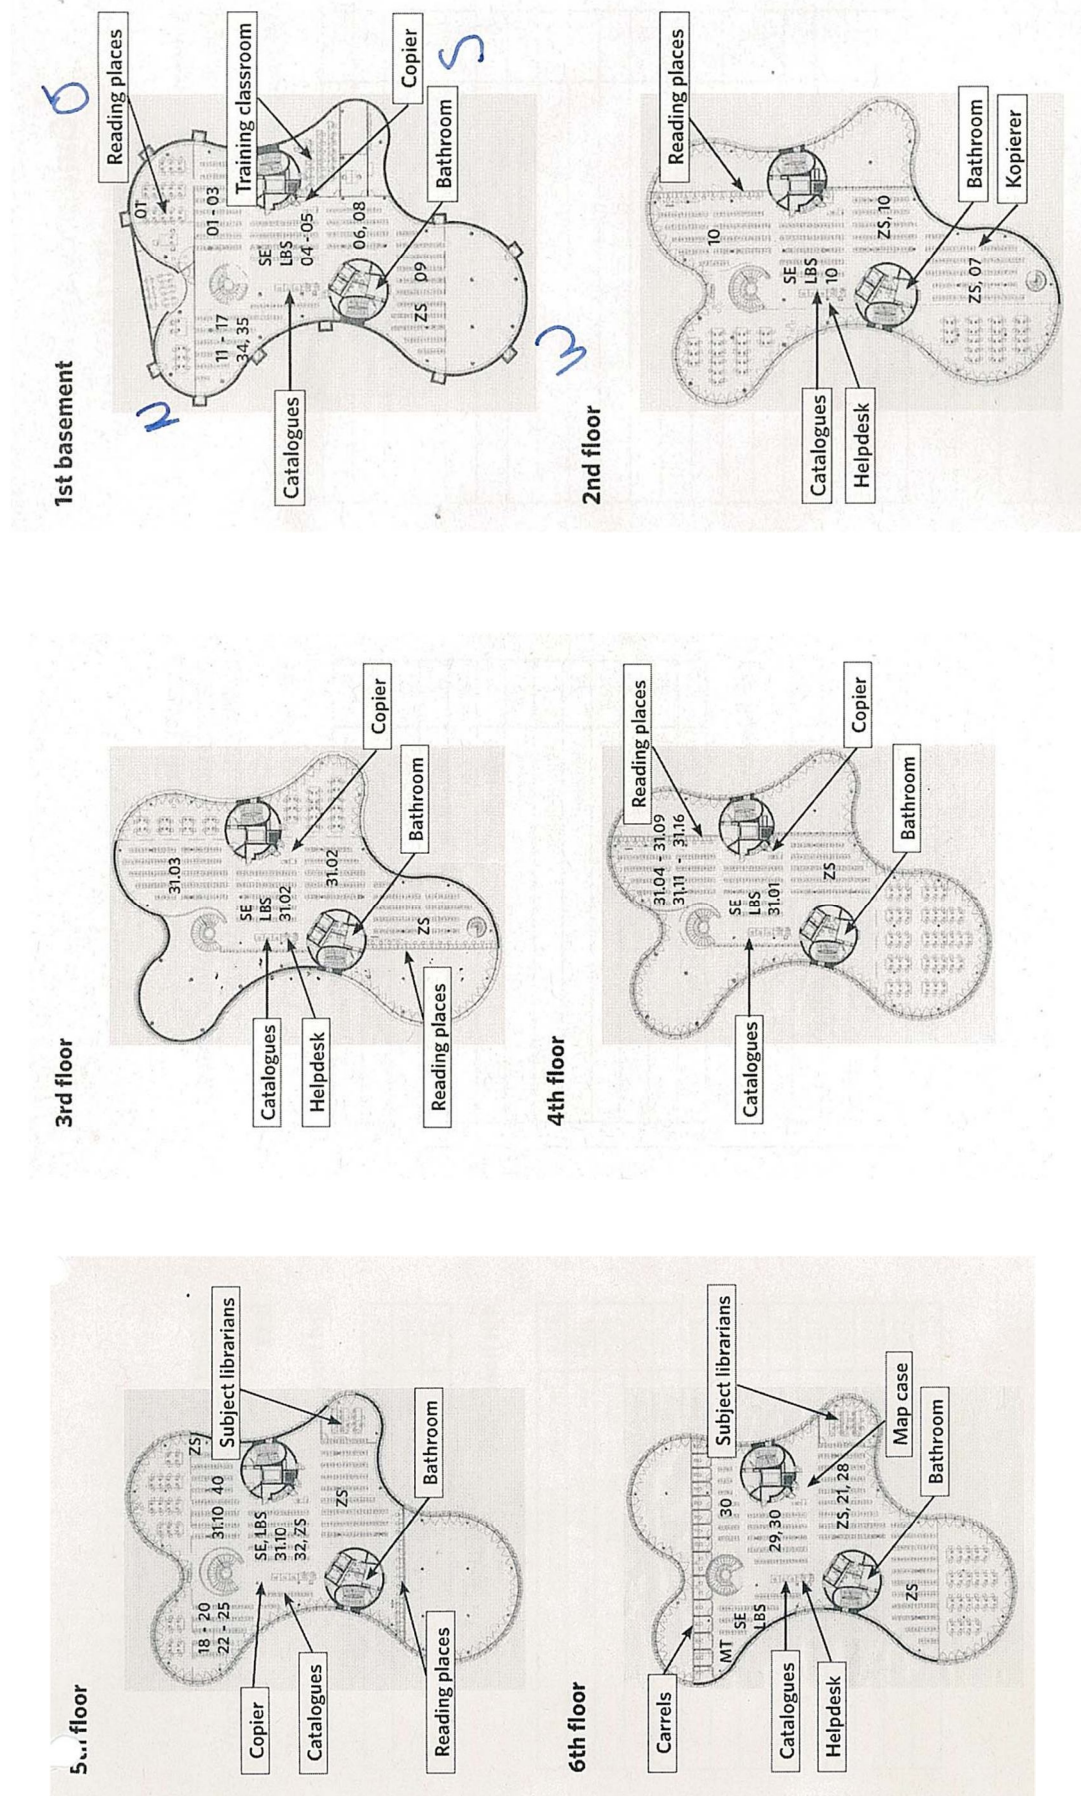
a, b, c: Grundrisse der einzelnen Stockwerke
